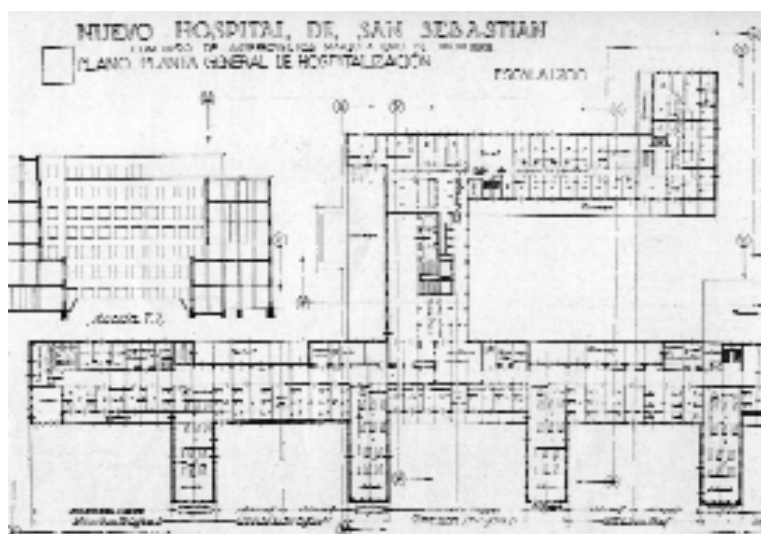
Planta del Hospital de San Sebastián del proyecto de Muguruza.
